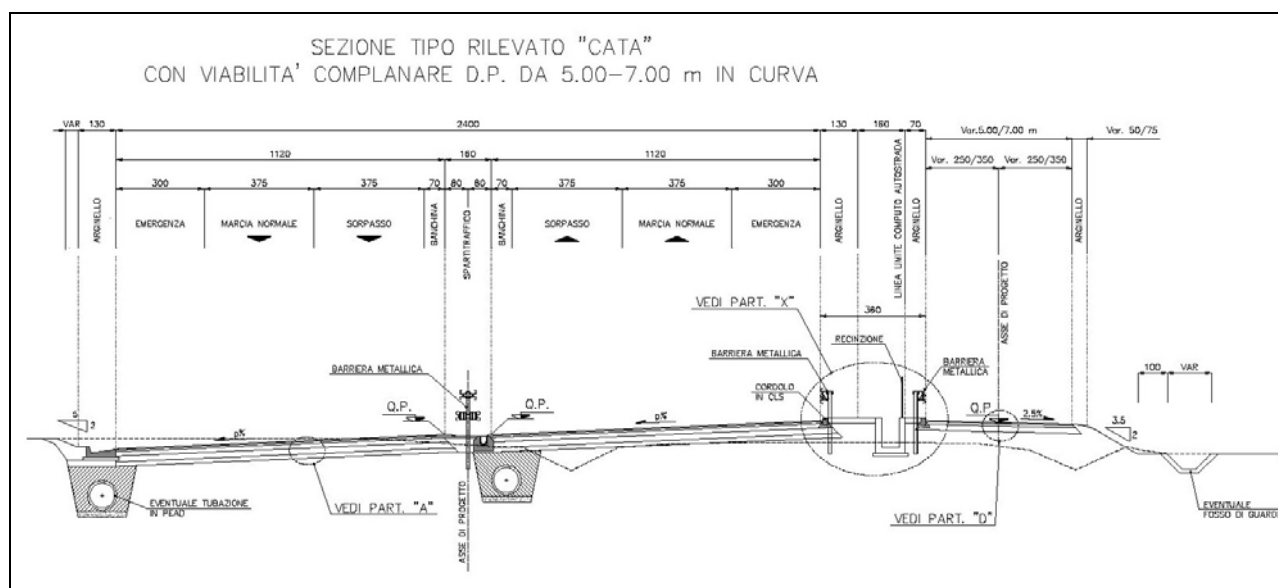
Sezione tipo di progetto con viabilità secondaria in complanare (adeguamento SS1 Aurelia)
